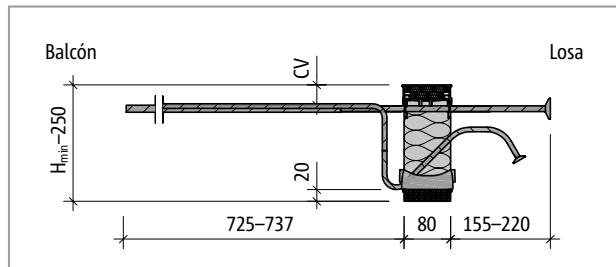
Schöck Isokorb® T tipo K-U-M2: Sección del producto
